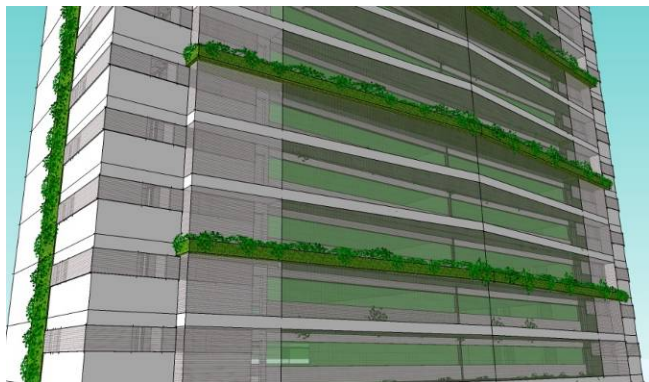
Detalhe esquemático da perspectiva da Fachada Norte.
